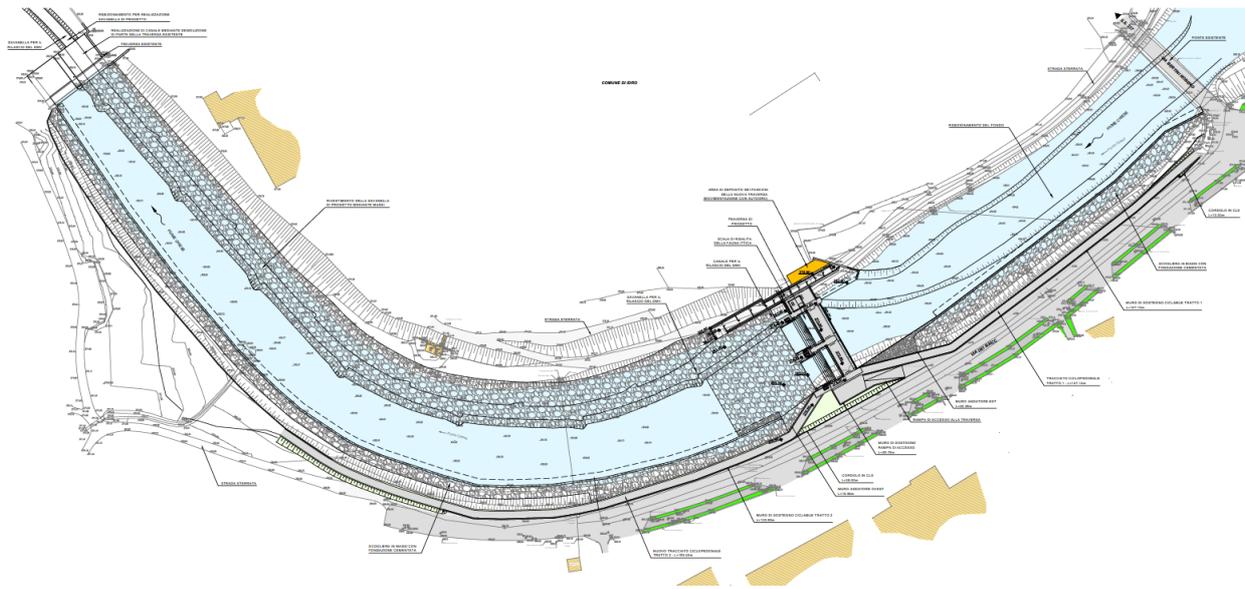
Planimetria nuova traversa e sistemazione alveo Fiume Chiese (elaborato: PE-NTR-OSD-GE-003-PL-A)
